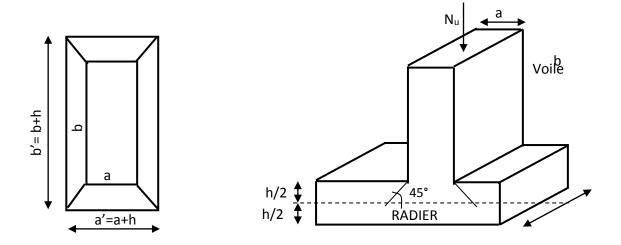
Périmètre utile des voiles et des poteaux
